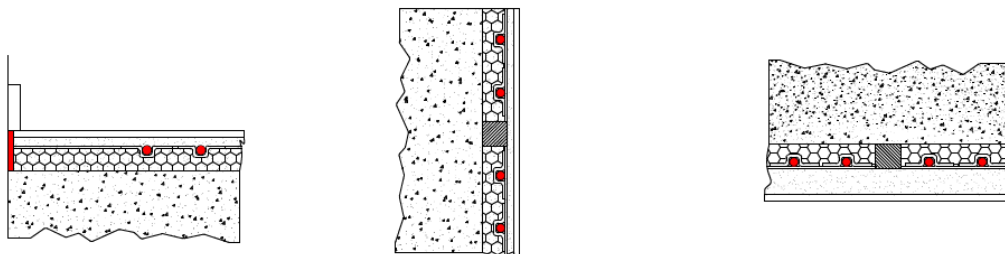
B. Sistema radiante TIPO B. Tubería instalada en aislamiento, con dispositivos de difusión térmica metálicos. La capa de difusión térmica puede ser metálica o de otros materiales. Desacoplado térmicamente mediante aislamiento plano o con forma.
